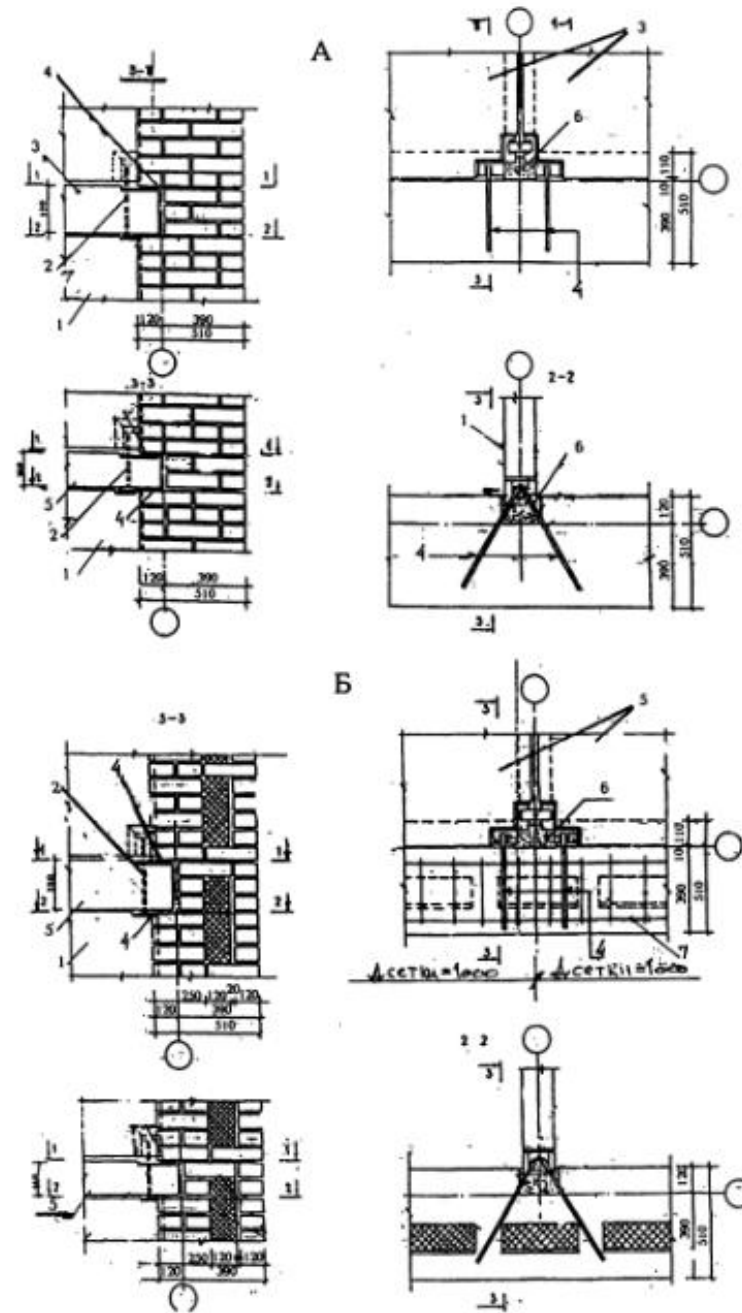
Узлы сопряжений конструкций здания комбинированной строительной системы (кирпичные наружные и железобетонные панельные внутренние стены): А, Б - наружные стены сплошной (А) и облегченной (Б) кладки; 1 - внутренняя стеновая панель; 2 - металлический анкер (при большом шаге внутренних несущих стен); 3 - плита перекрытия (220 мм); 4 - отдельные металлические стержни; 5 - плита - настил (160 мм); 6 - бетон; 7 - арматурная сетка
